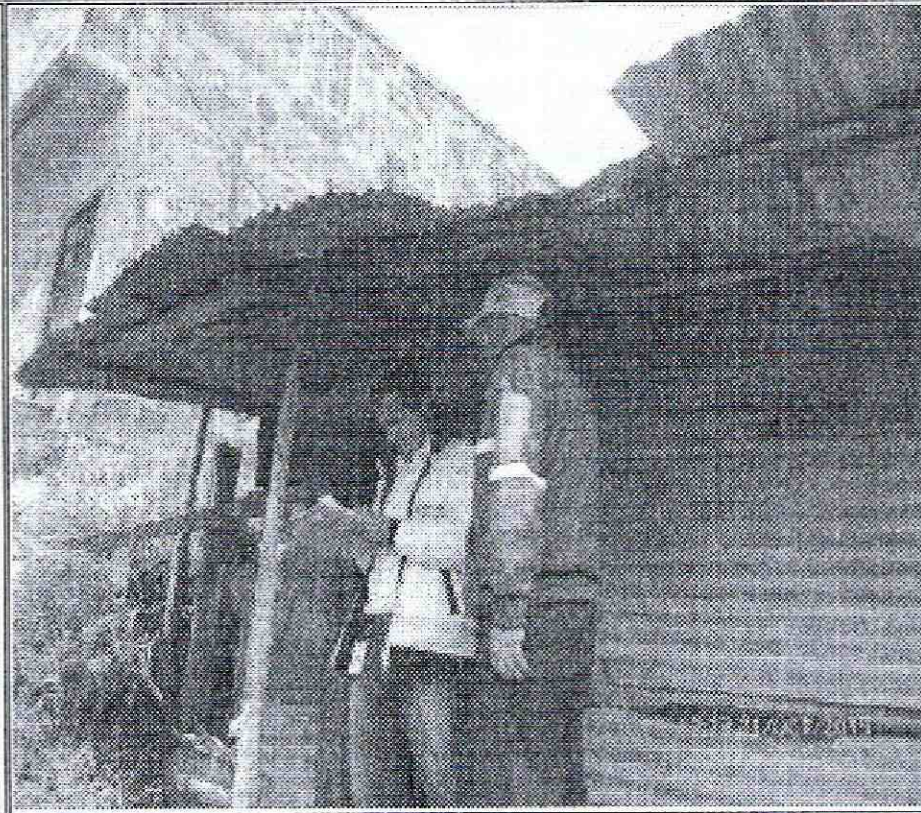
Vista frontal Predio 1 con coordenadas N95151.68 – E91084.77
